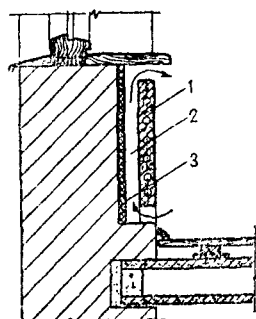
Установка прибора панельно-лучистого отопления в здании с каменными наружными стенами
